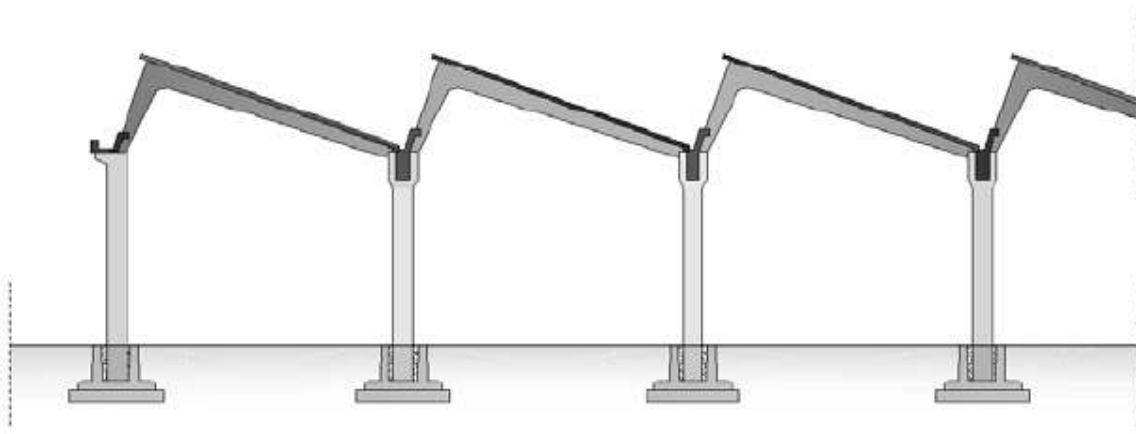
Esempio di copertura a shed con travi a ginocchio
